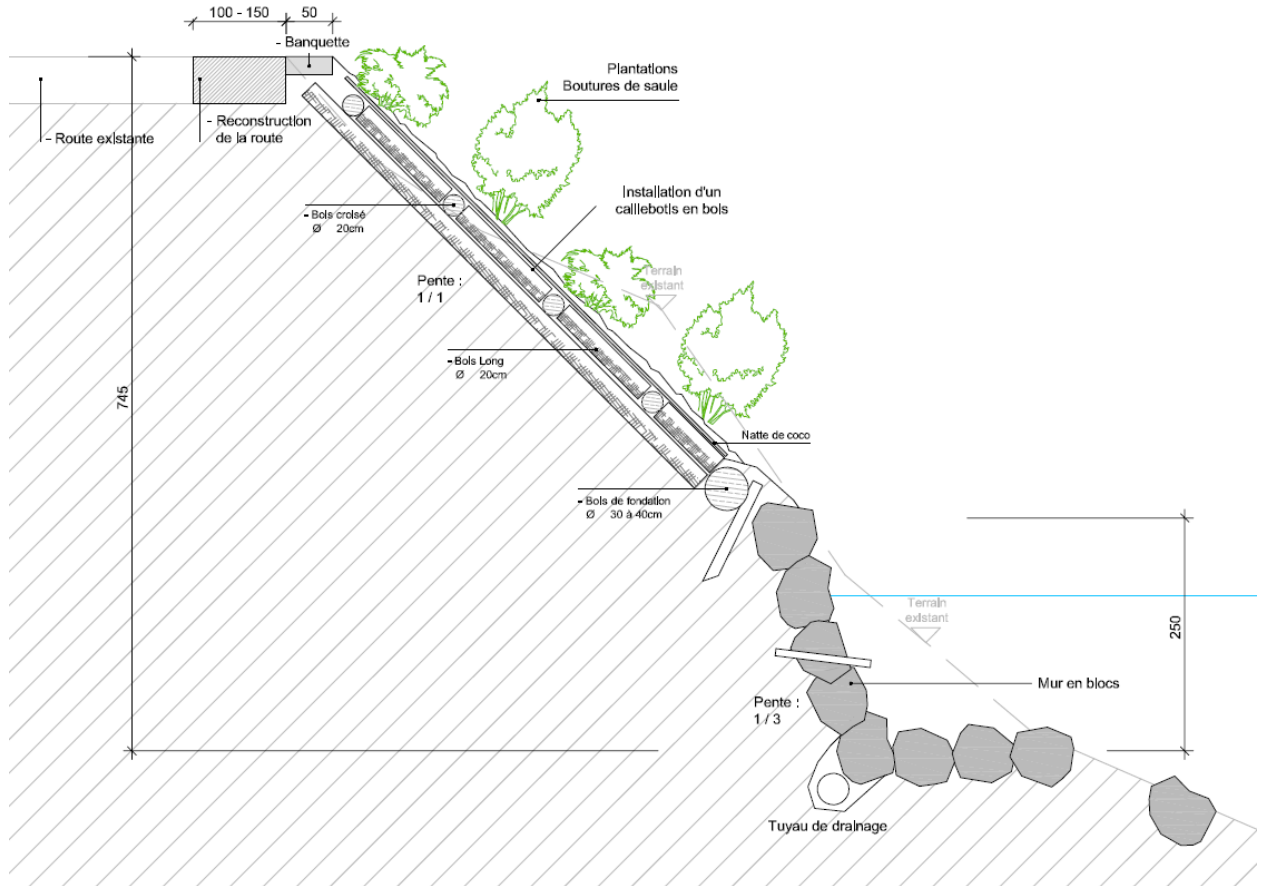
Proposition d'assainissement : mur en blocs et grille en bois (plan de profil)
